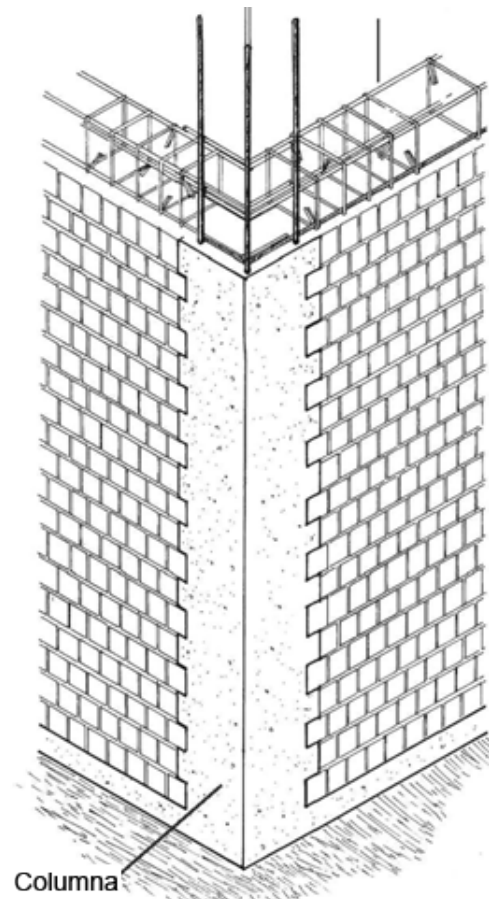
Detalle de las barras de refuerzo en un pilar de esquina, encuentro en L (Totten, 2010)
